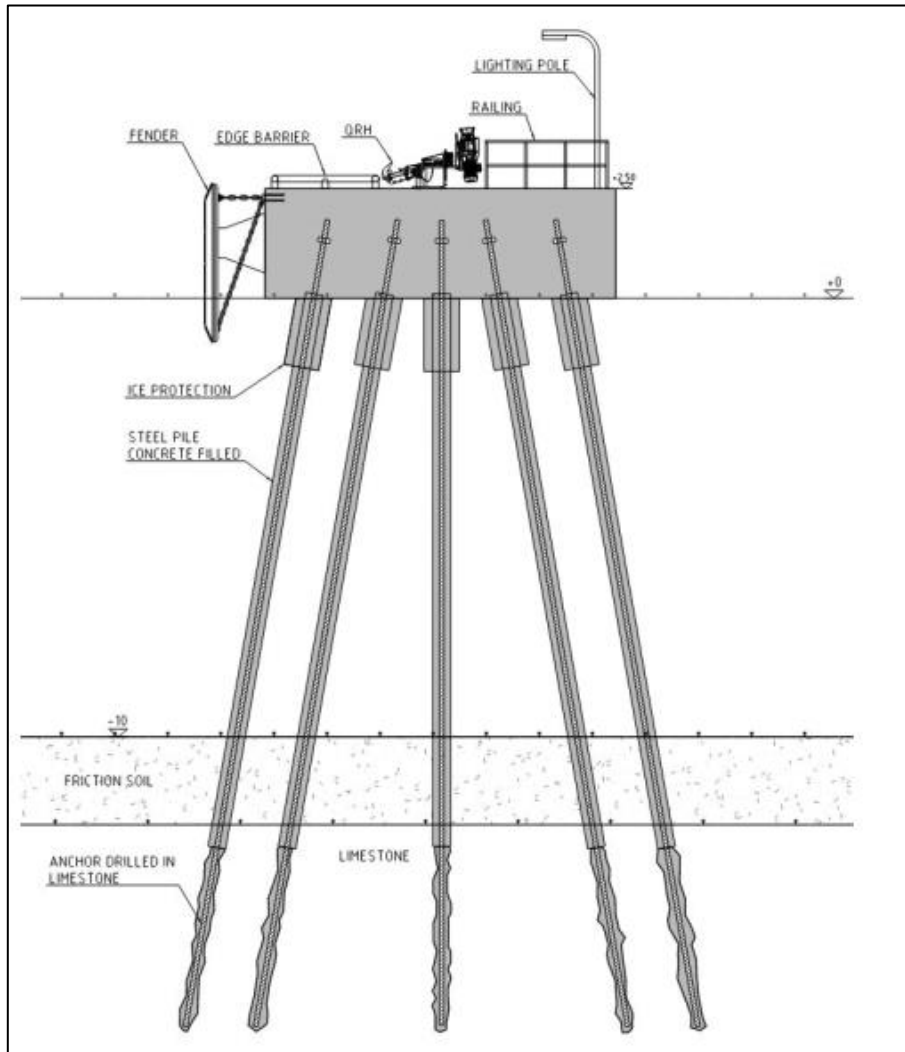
Principskiss för grundläggning av den inre plattformen.
